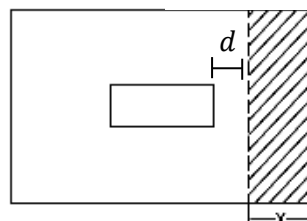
Sección crítica para la verificación del corte por flexión.
